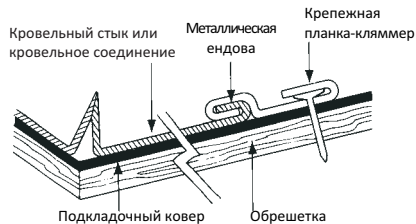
Крепление металлической ендовы металлическими крепежными планками (кляммерами).
